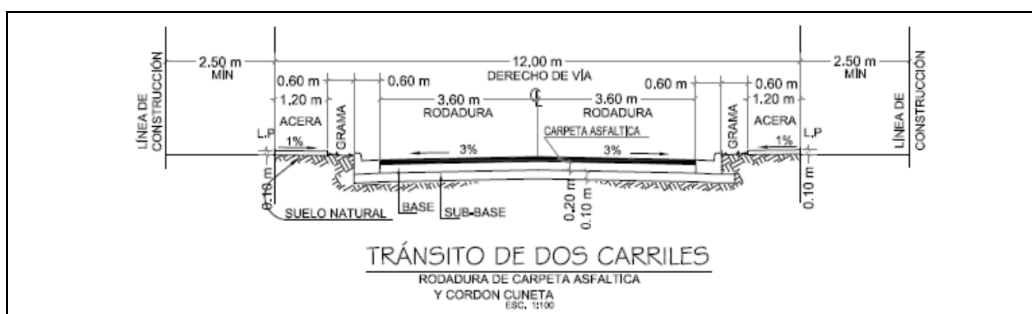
Sección de calle de 12 m. Fuente: Plano de anteproyecto aprobado
